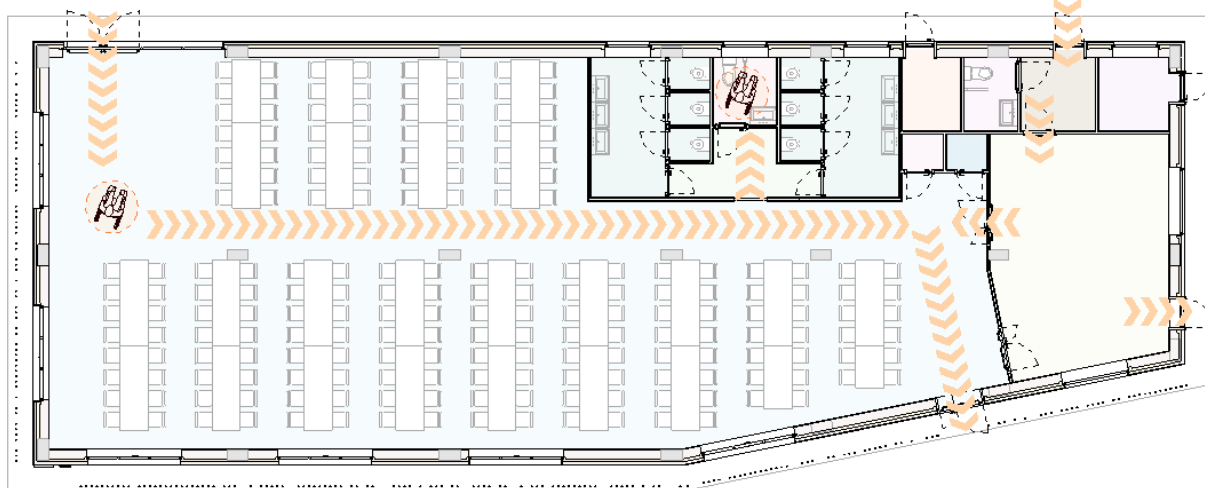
Pianta funzionale della struttura con distribuzione dei locali
